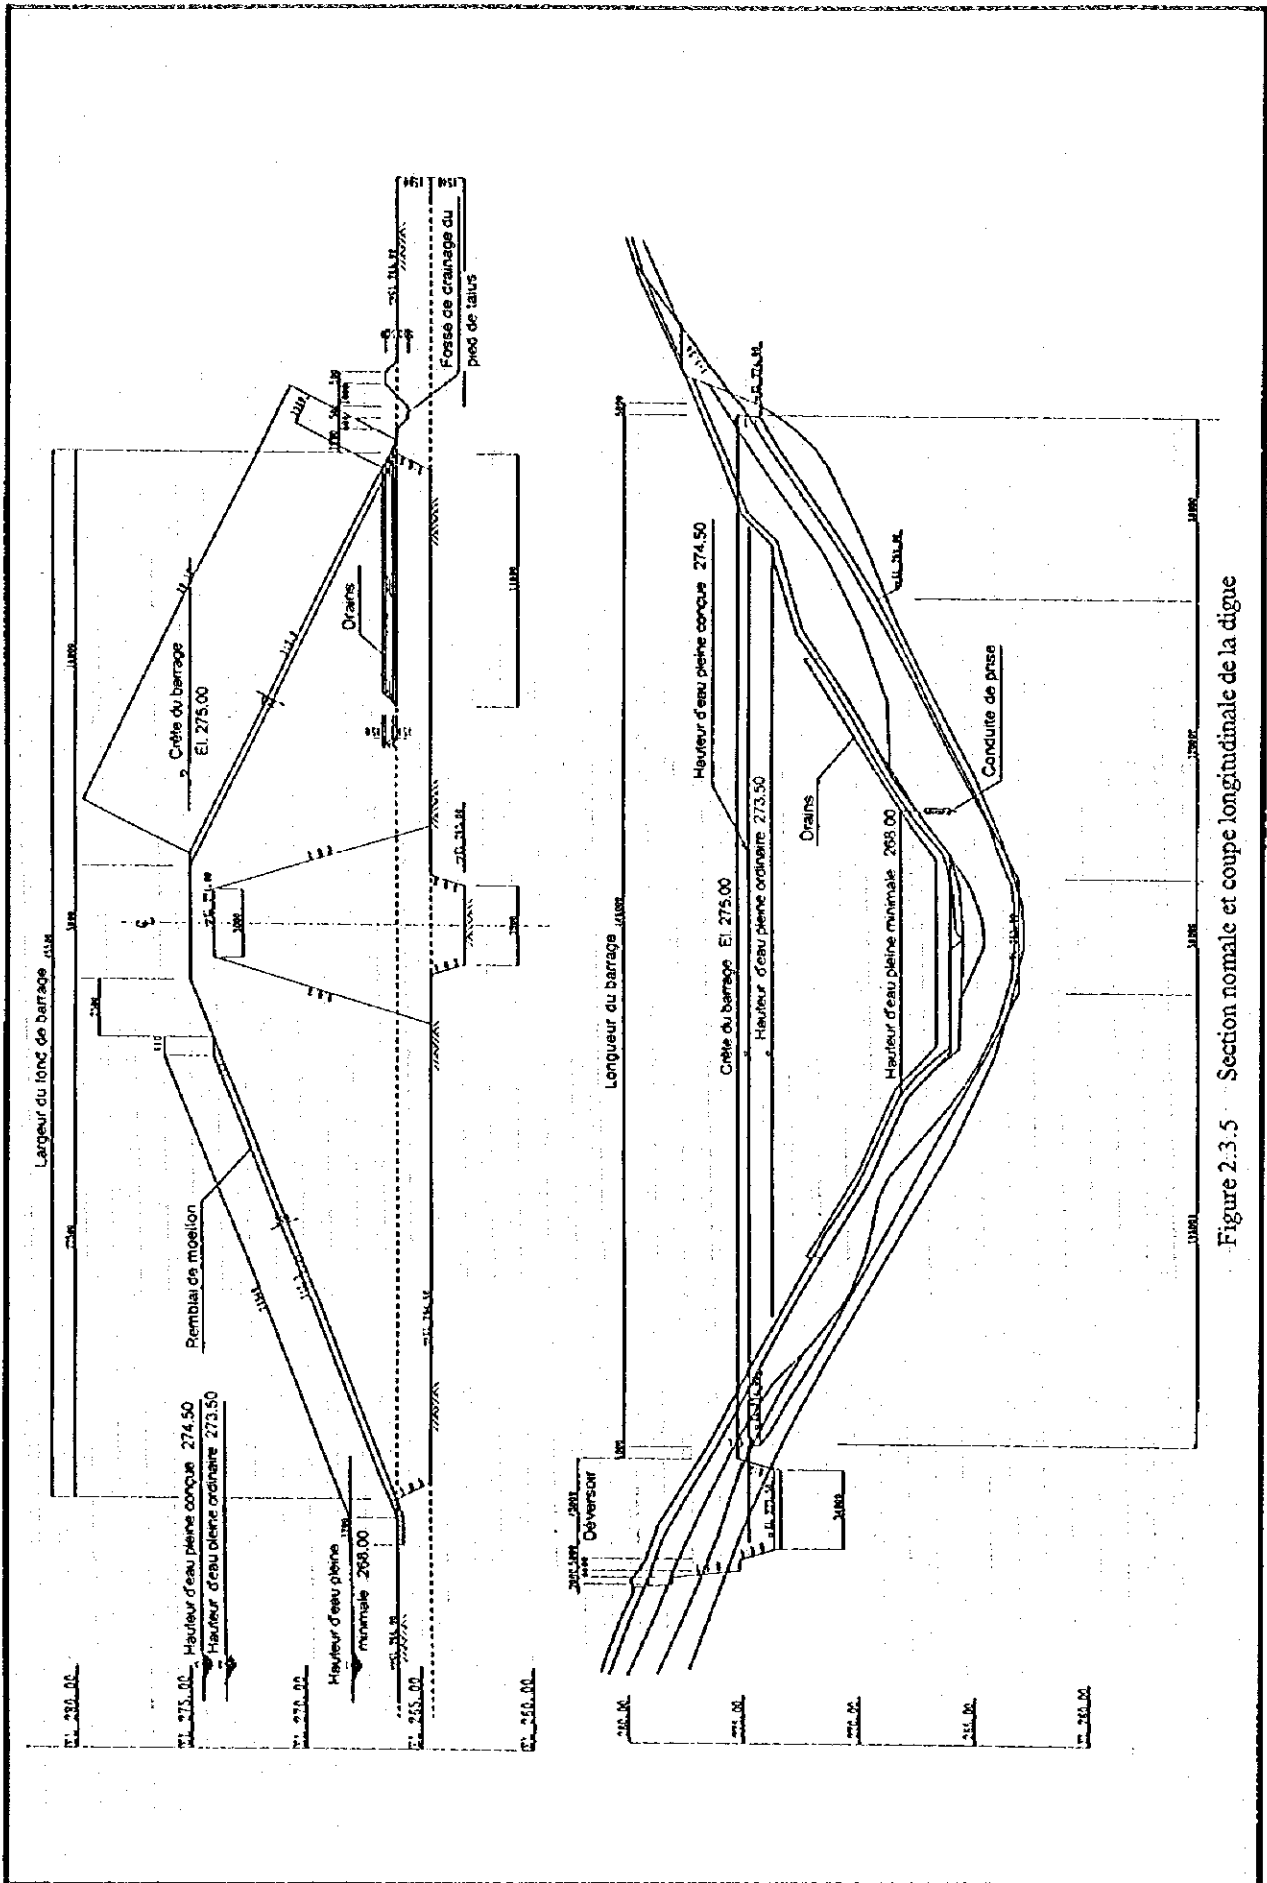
Section normale et coupe longitudinale de la digue
